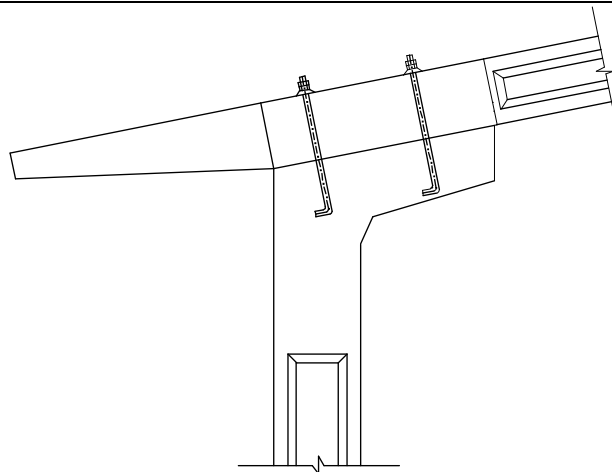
Ligação viga-pilar - sistema parafuso.
